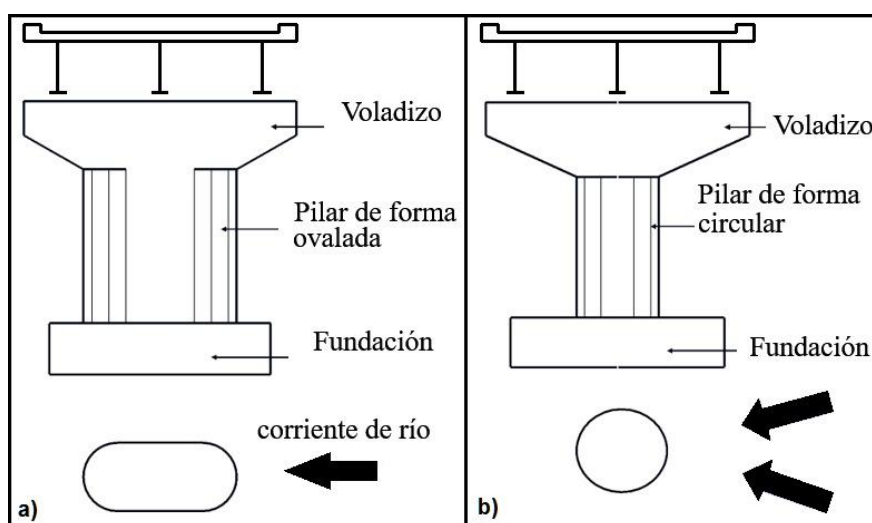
Pilar de forma a) ovalada y b) circular. Fuente: Cortesía del proyecto GENSAI.
